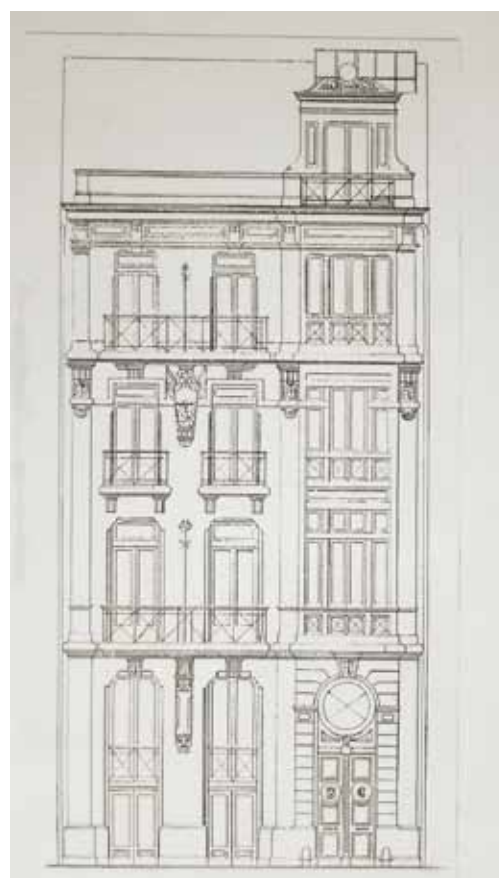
Edificio de Benito Conde en la calle de la Muralla, Gijón.
